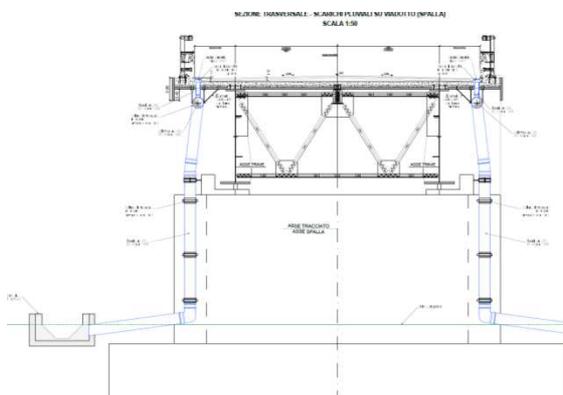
Stralcio elaborato T00ID02IDRDC03_A Sistema di raccolta acque di piattaforma in viadotto – corrispondenza spalle
